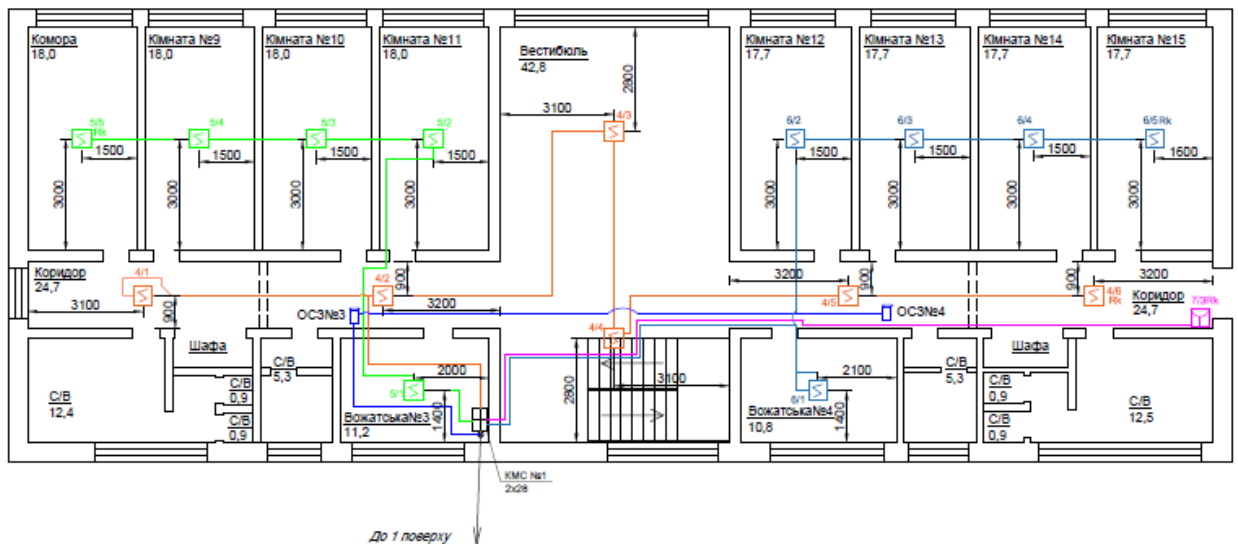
План захищаних приміщень 2-го поверху
